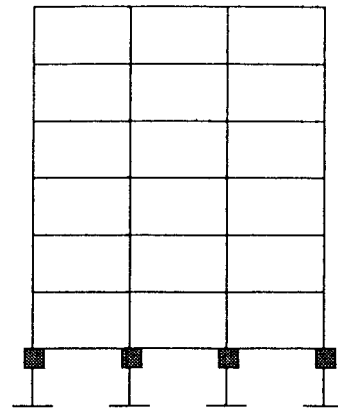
Tingkat 5 lantai ke 3
